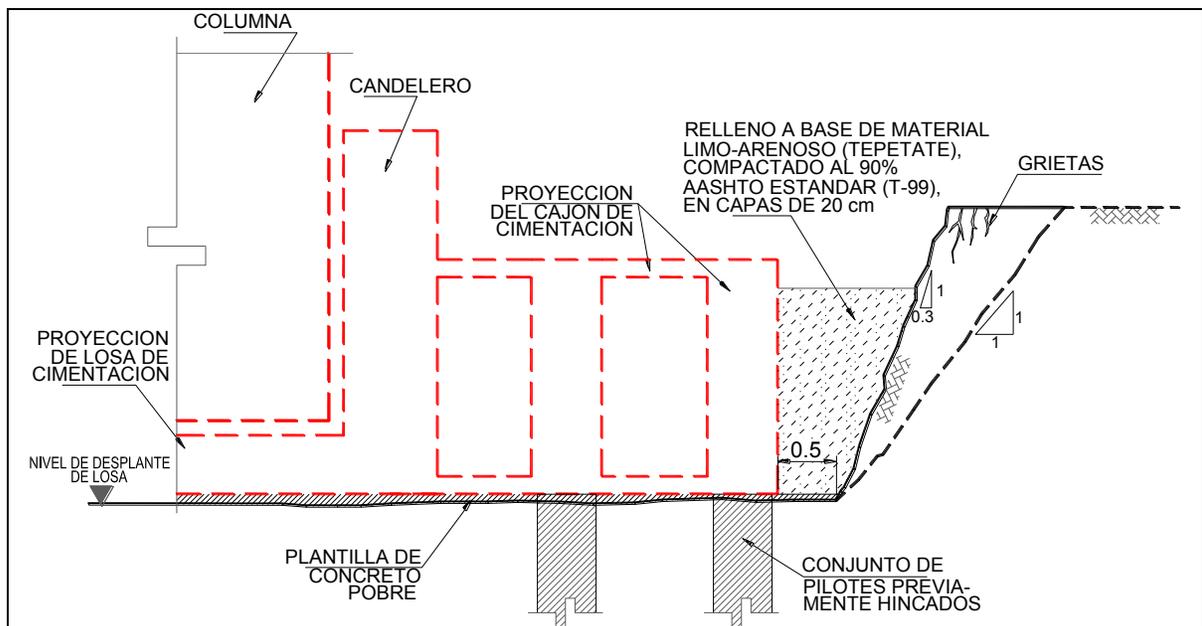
Perfil de la geometría de una zapata indicando relación de taludes.
